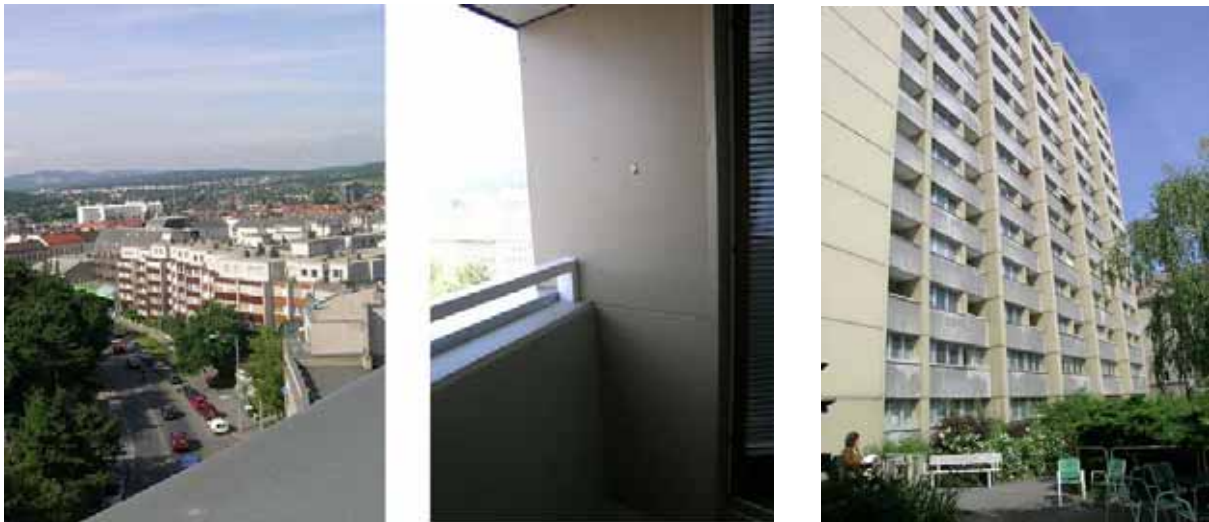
Ausblick mit hoher Brüstung, Abb. 229 Fassadenstruktur mit Loggien
